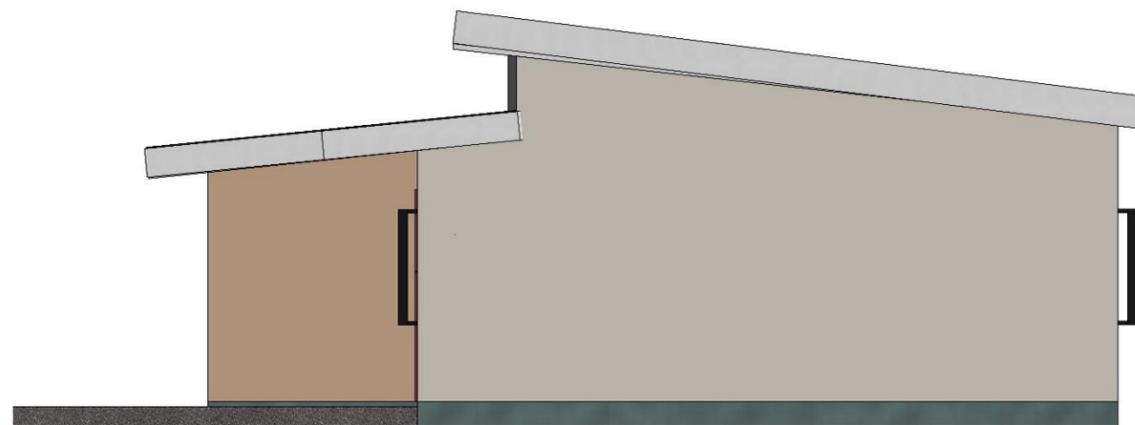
Fachada Norte - Vivienda Modelo C-12.
